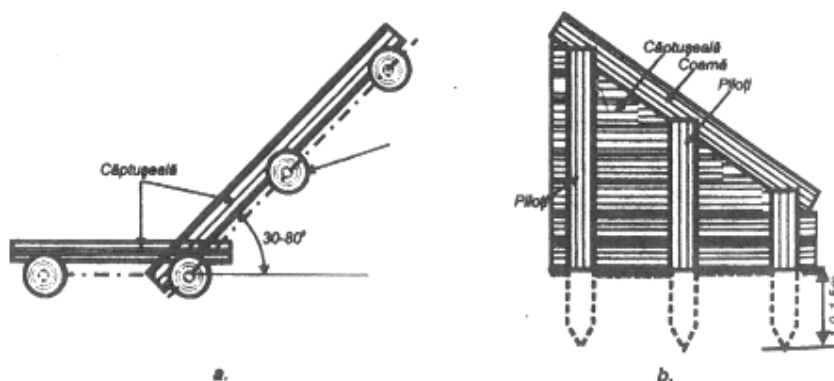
Aripă din lemn: a - în plan orizontal; b - în elevatie
